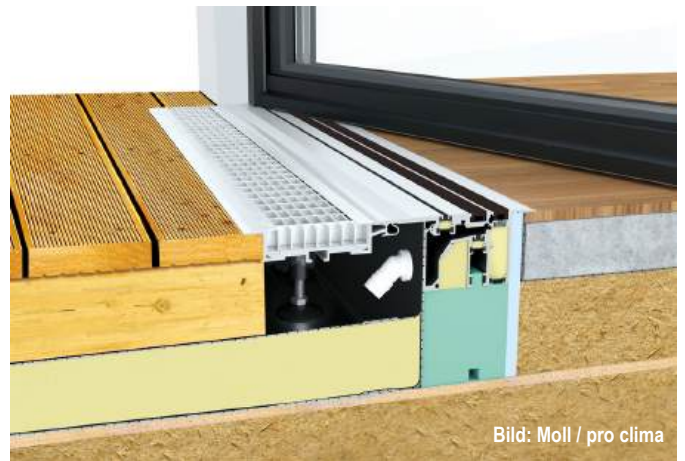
Sonderlösung: Barrierefreier Zugang zu einer Dachterrasse in Holzbauweise durch Einsatz einer Schwelle mit Magnetdichtung und integrierter Entwässerung.
